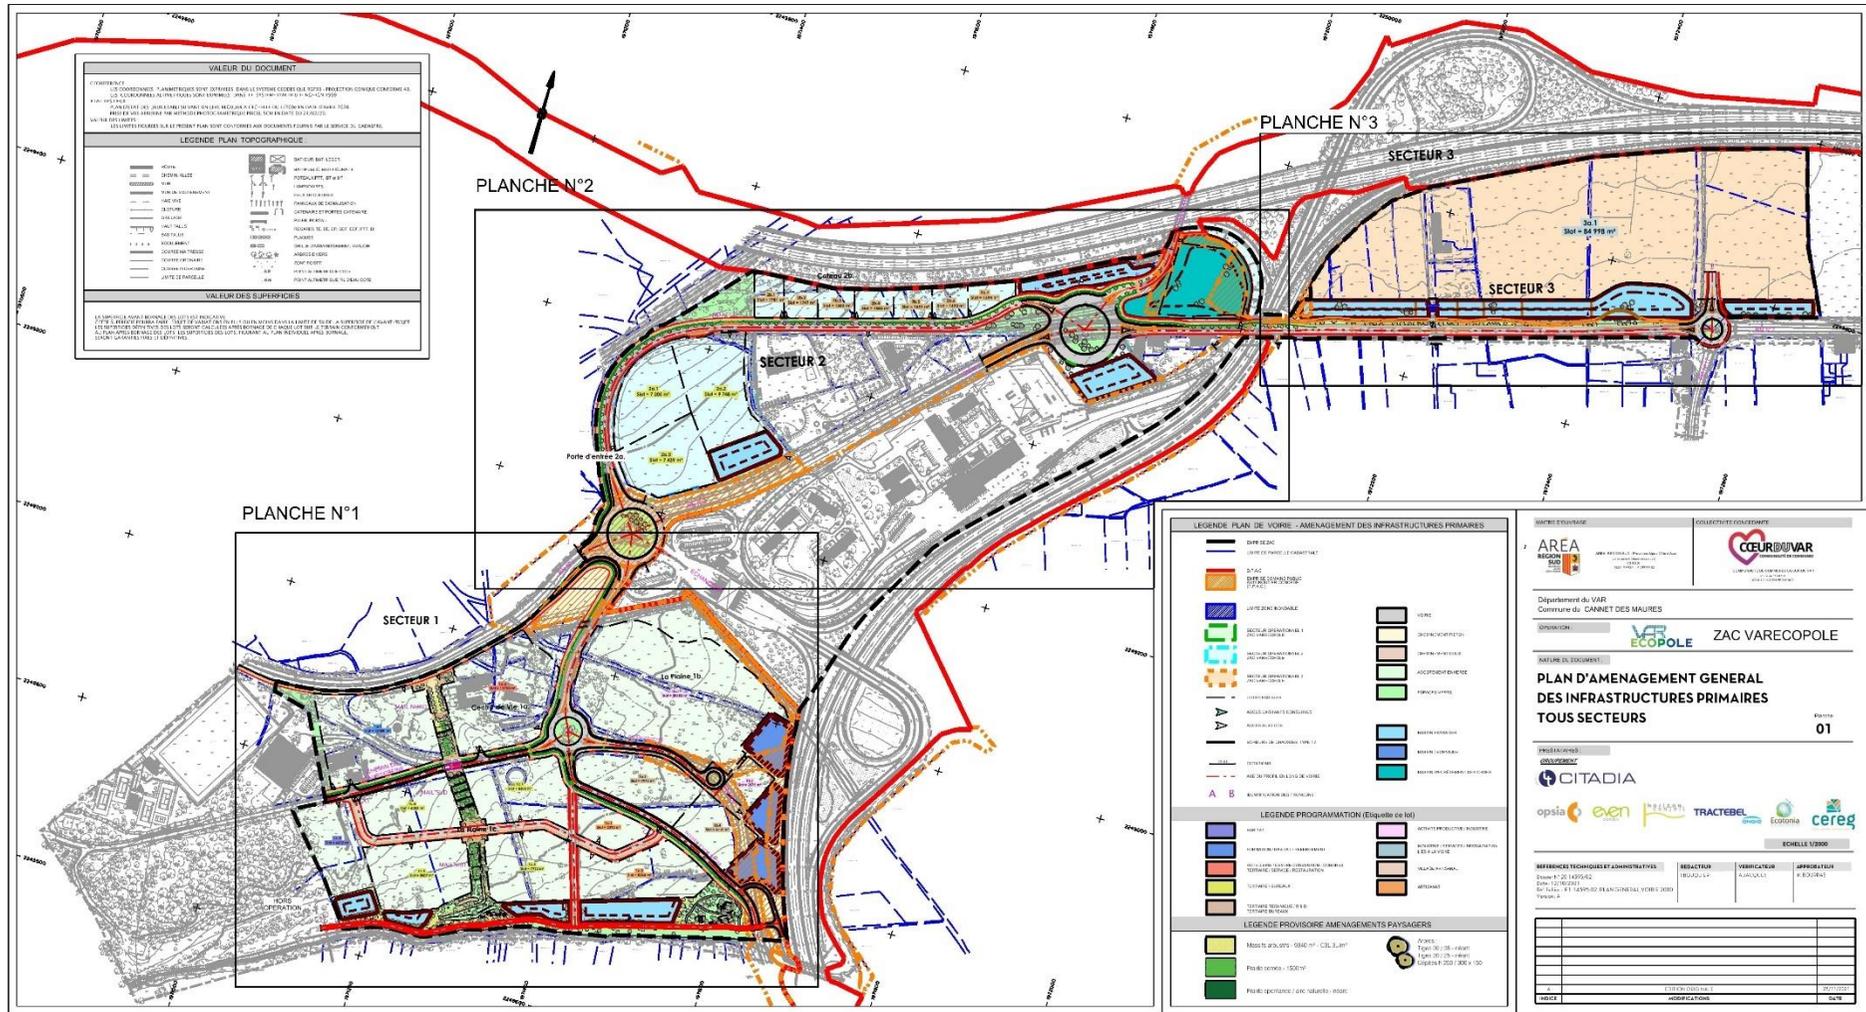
Plan de masse final du projet d'implantation de la ZAC
